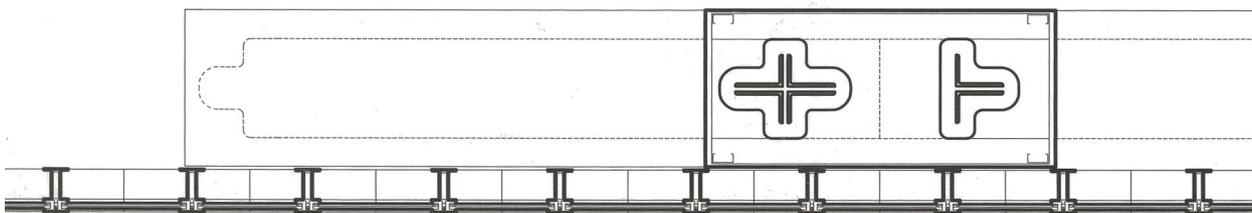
Derecha: Dibujo de alzado frontal exterior. Abajo: corte horizontal de fachada.
